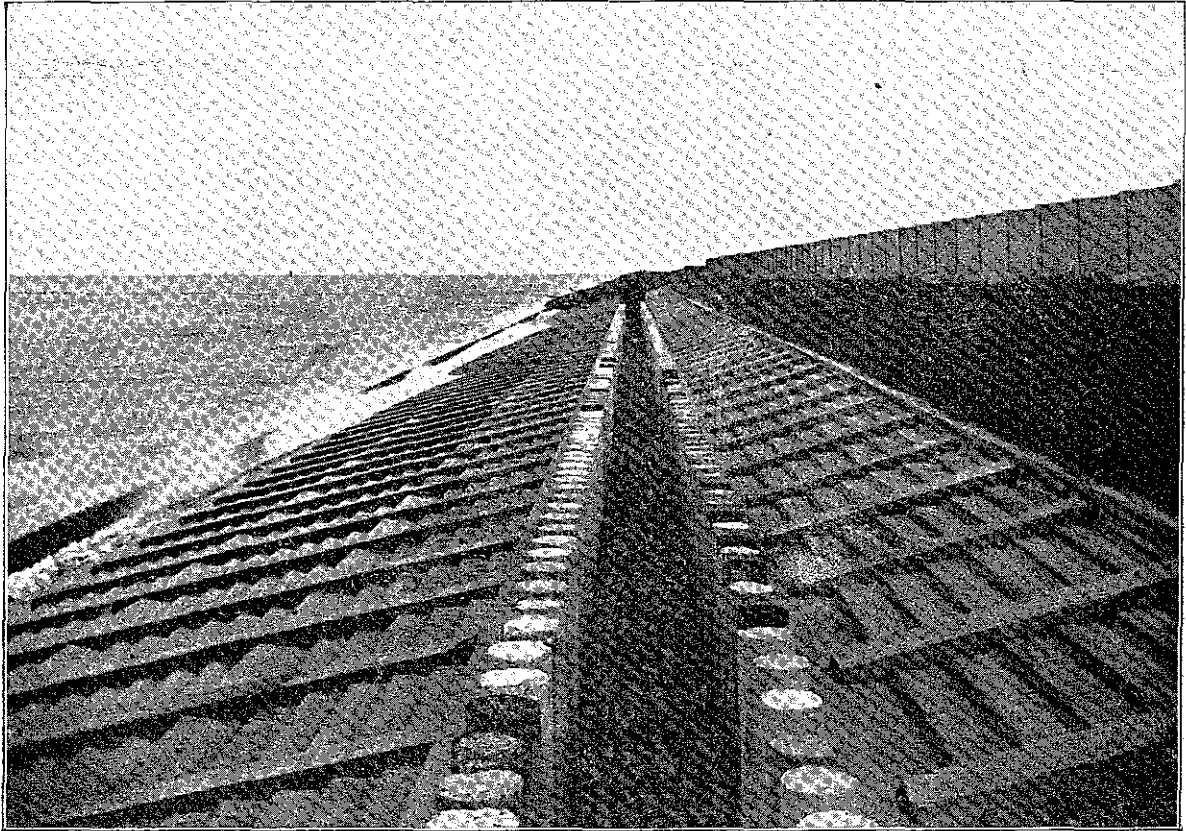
Betonglooiing enz op den Langendijk van Schouwen. Foto genomen in 1908.
